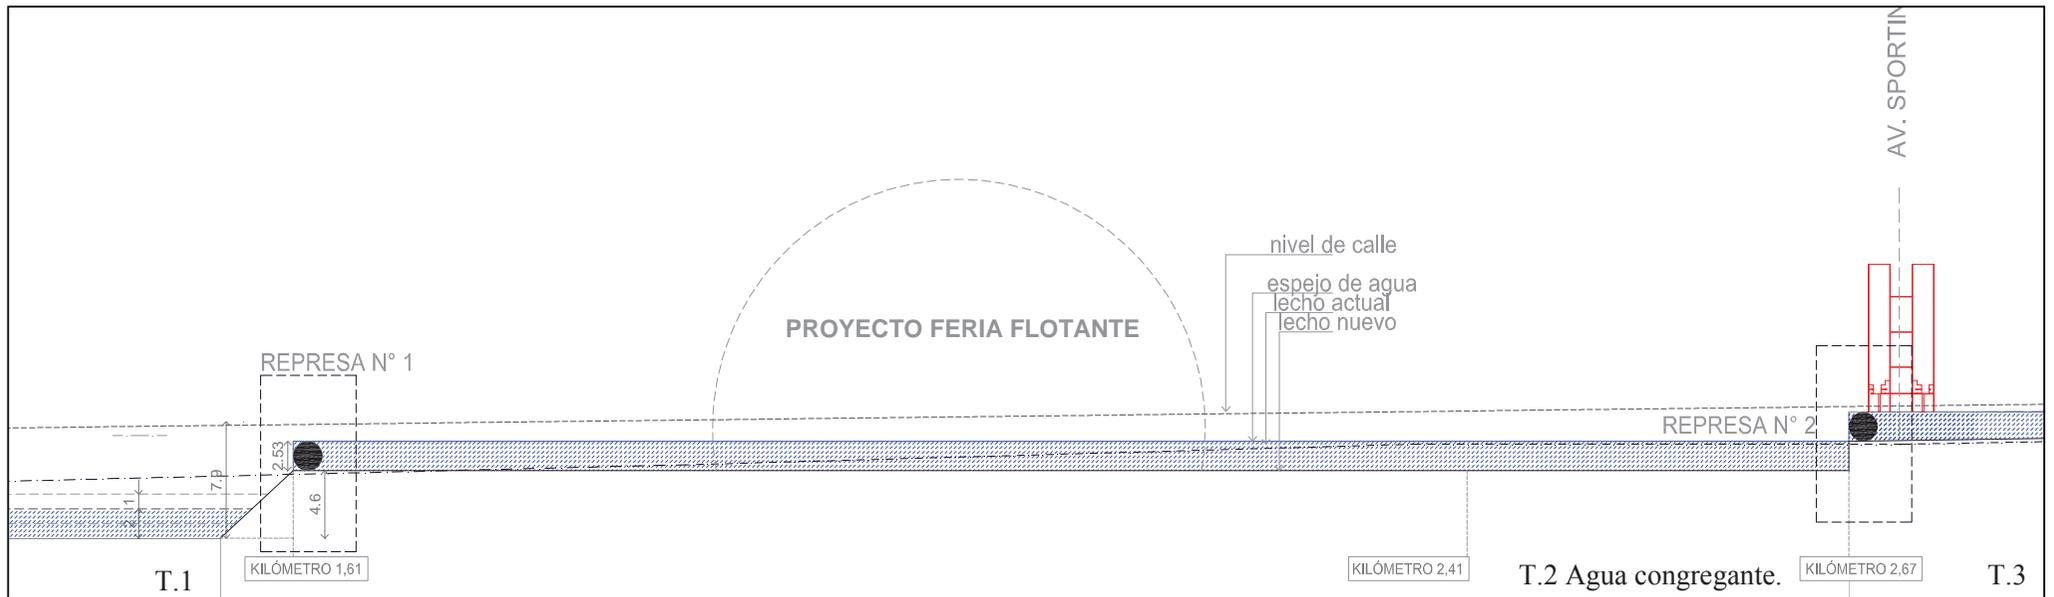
Planos Homero Latorre. Corte longitudinal tramos 2, Pendiente cero y lecho pavimentado, el espejo de agua se ubica entre dos represas inflables.
